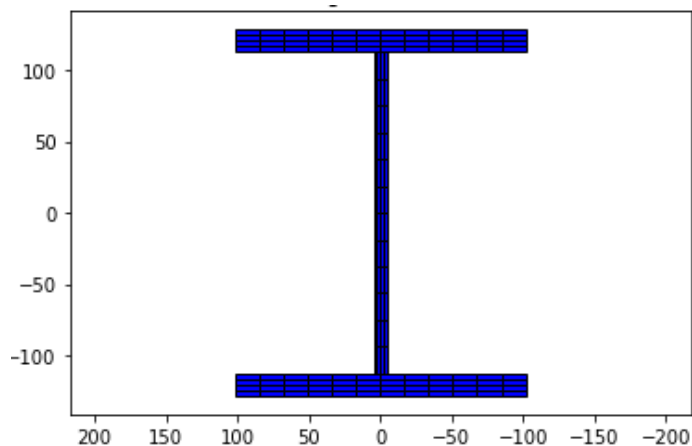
Modelo tipo de la sección transversal de vigas y columnas
